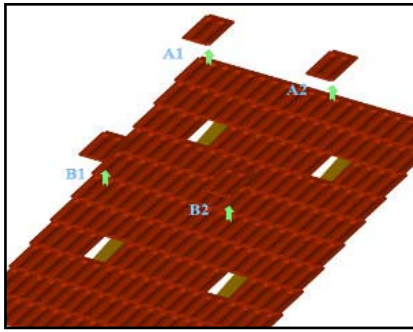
Accessoires de fixation pour montage sur toiture en tuiles mécanique inclinée à 32° maximum.
